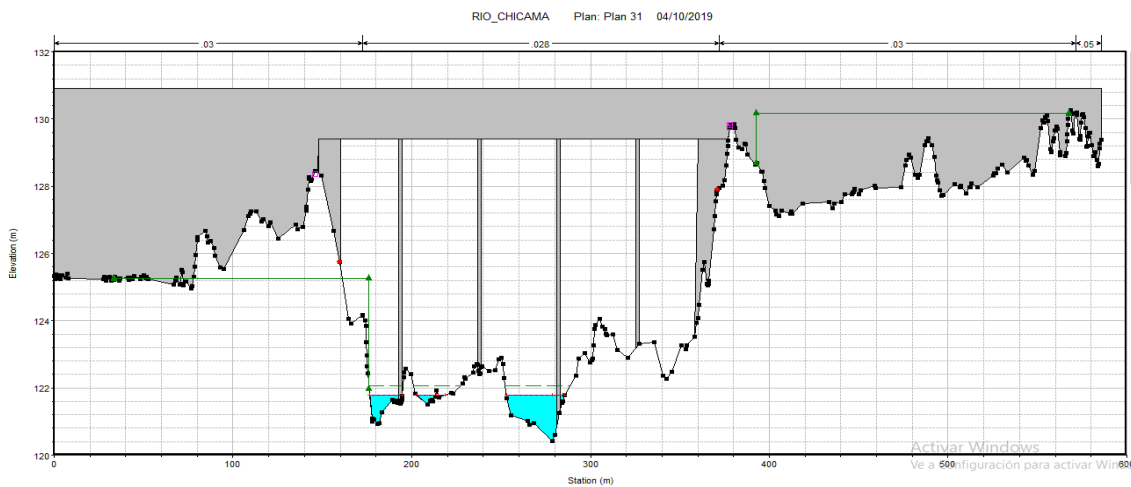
Sección puente Careaga en PF1 con un tirante de 1.94 m.
